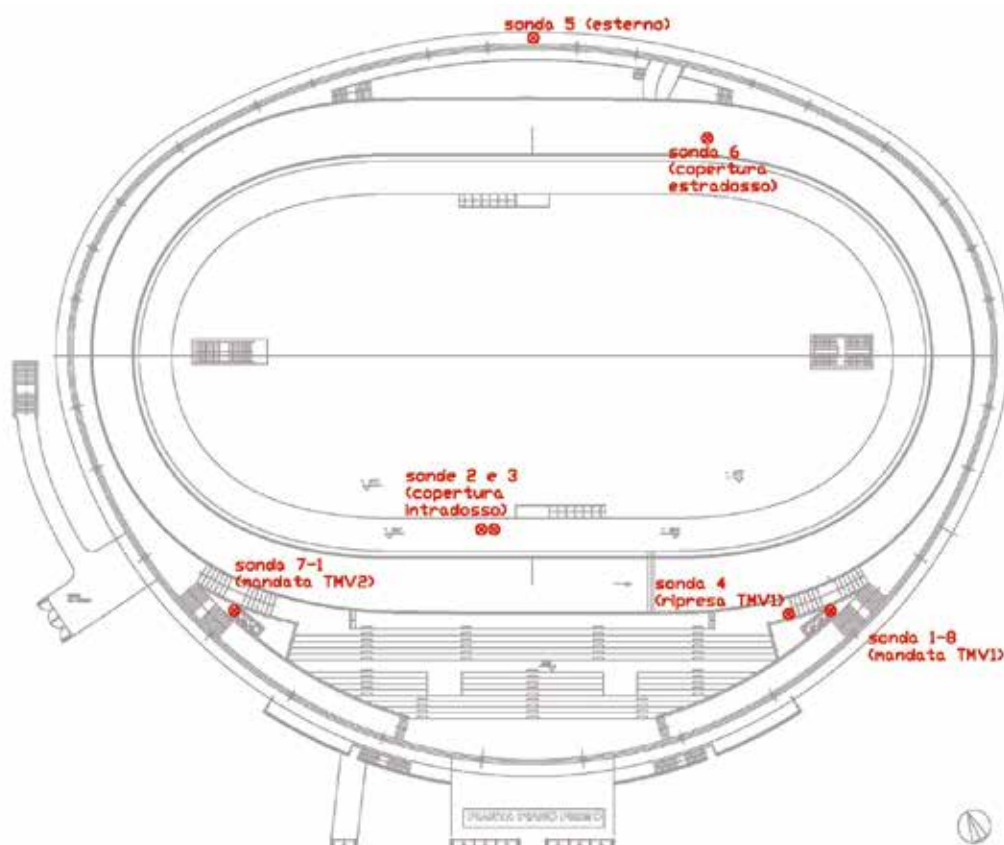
Rappresentazione in pianta della posizione degli strumenti di misura
